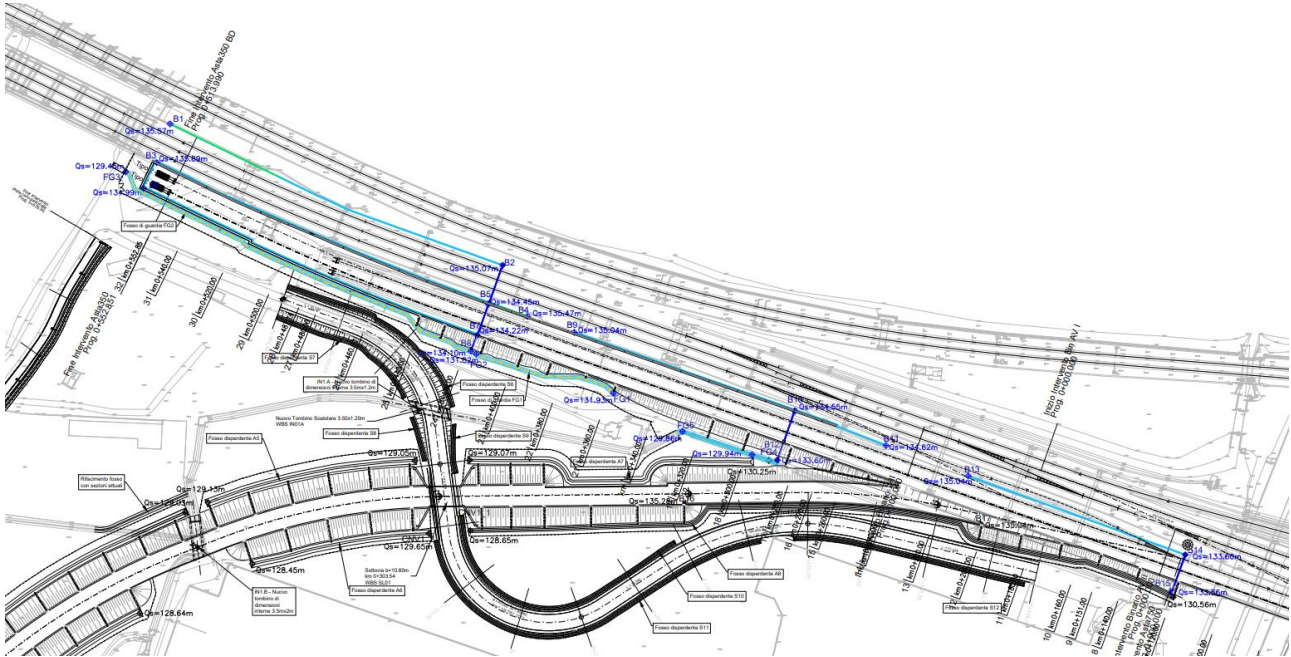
Stralcio planimetria di smaltimento idraulico – Stralcio elaborato IN1M10D26P7ID0002001A
